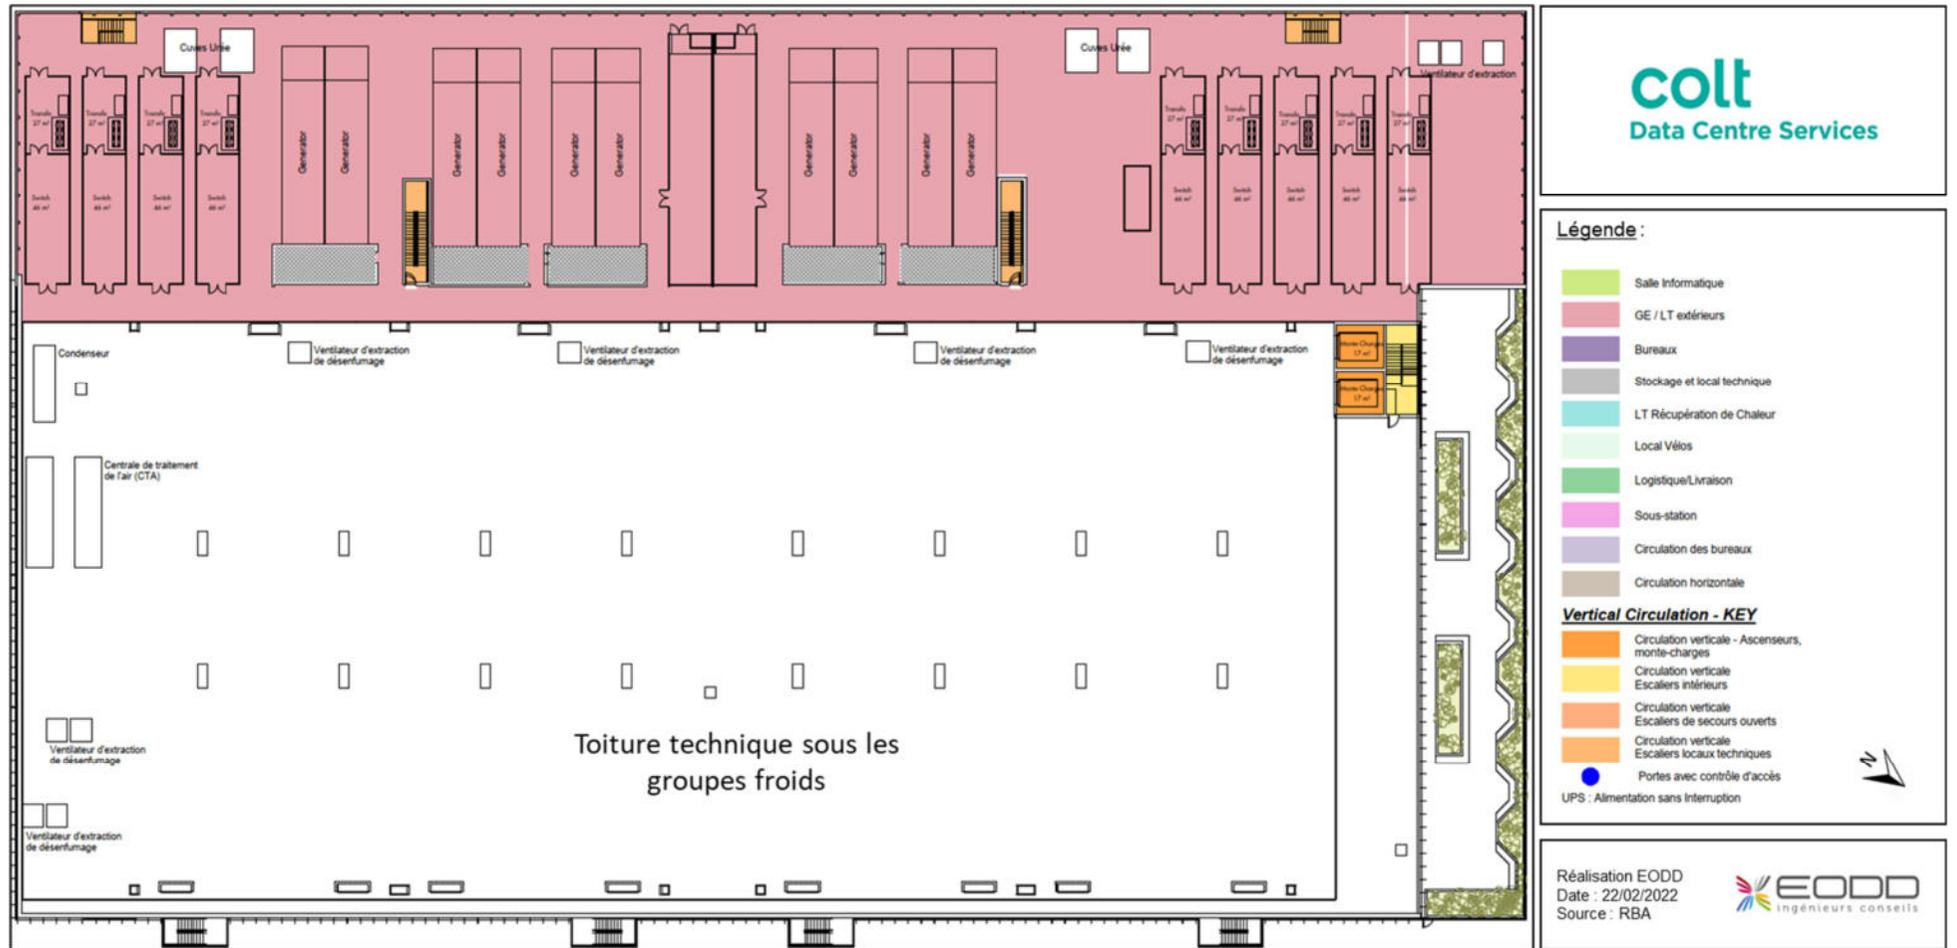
Répartition des locaux et installations – Toiture Niveau 1
